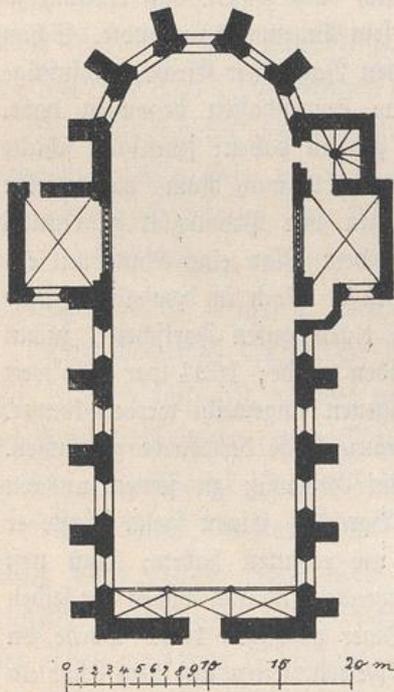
Maubeuge. Ehemalige Jesuitenkirche. Grundriß.
